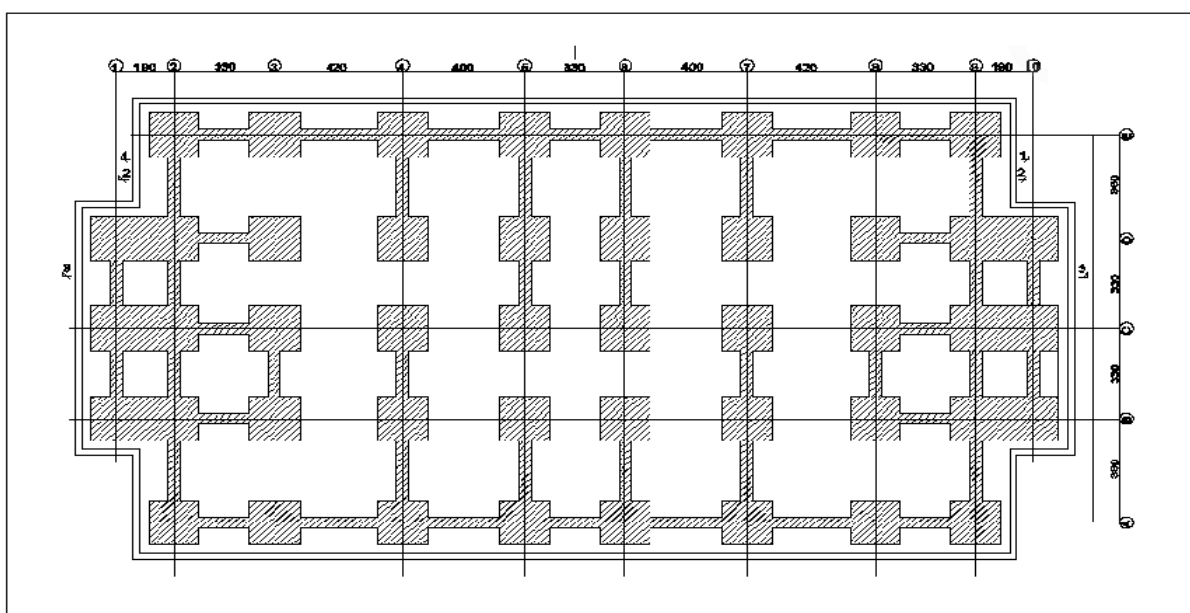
Plan de coffrage de fondation pour une structure isolée
